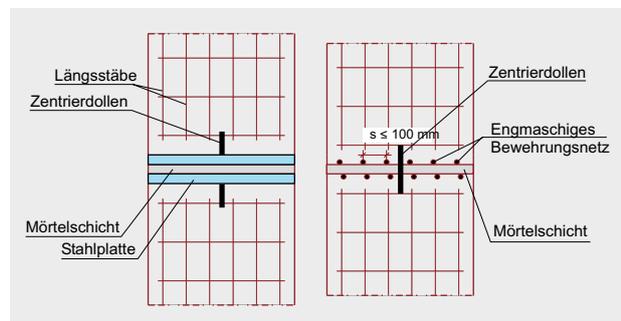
Stützenstoß mit Stahlplatte (links), Stirnflächenbewehrung (rechts)
